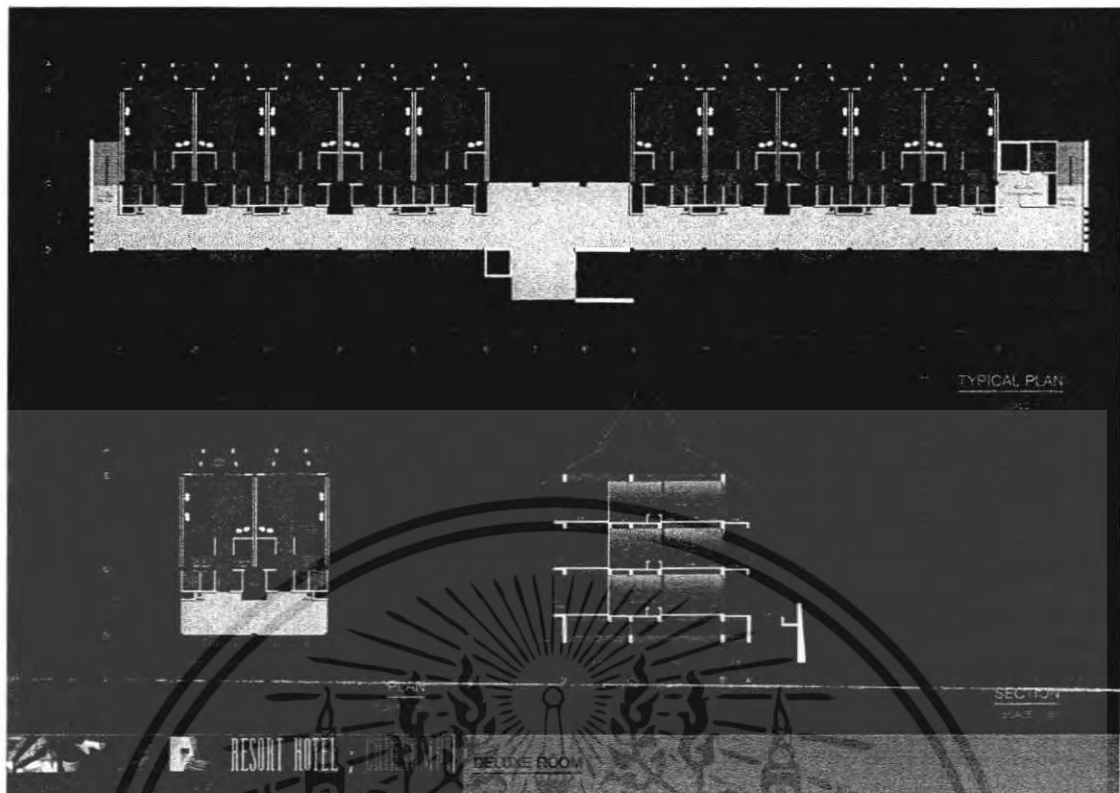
แสดงผังพื้นชั้นสอง (2nd Floor Plan)
